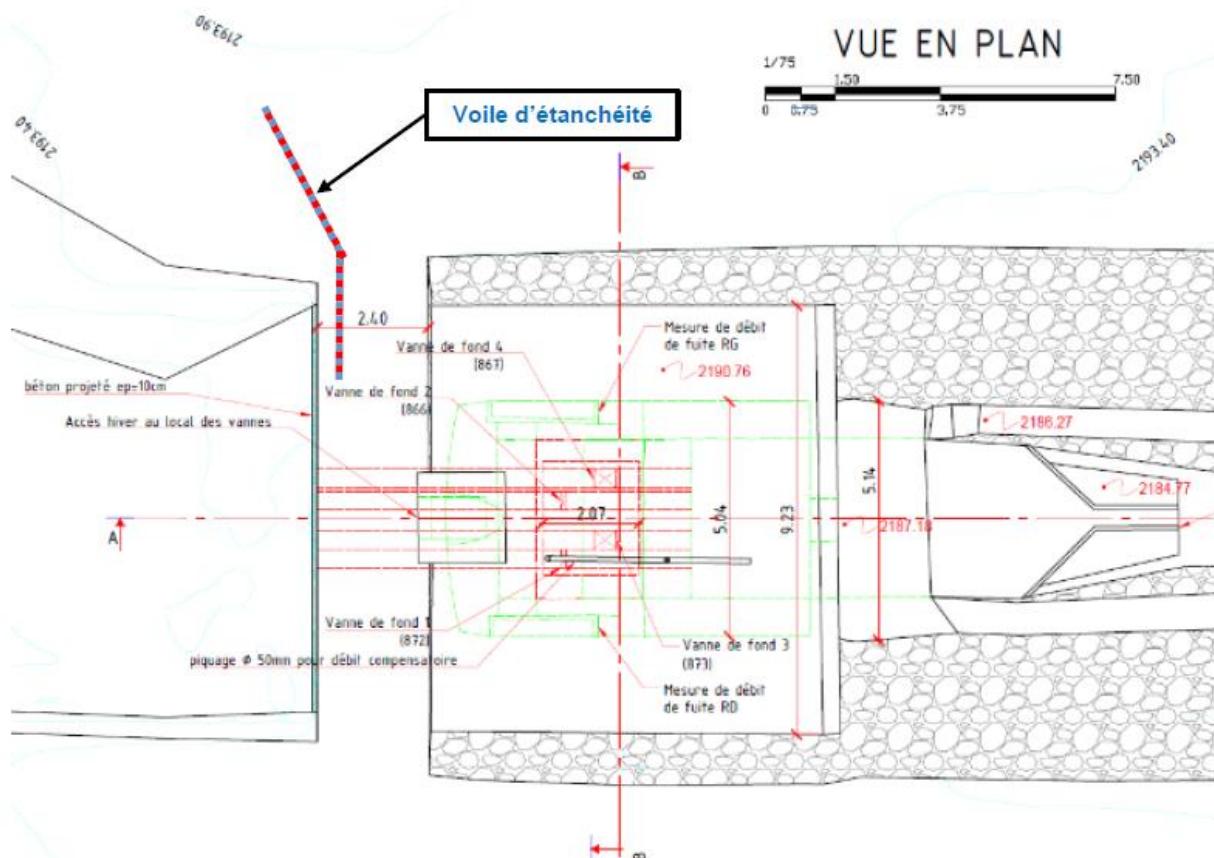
Barrage – Vue en plan – Voile d'injection de traitement du terrain (EDF, 2025)
